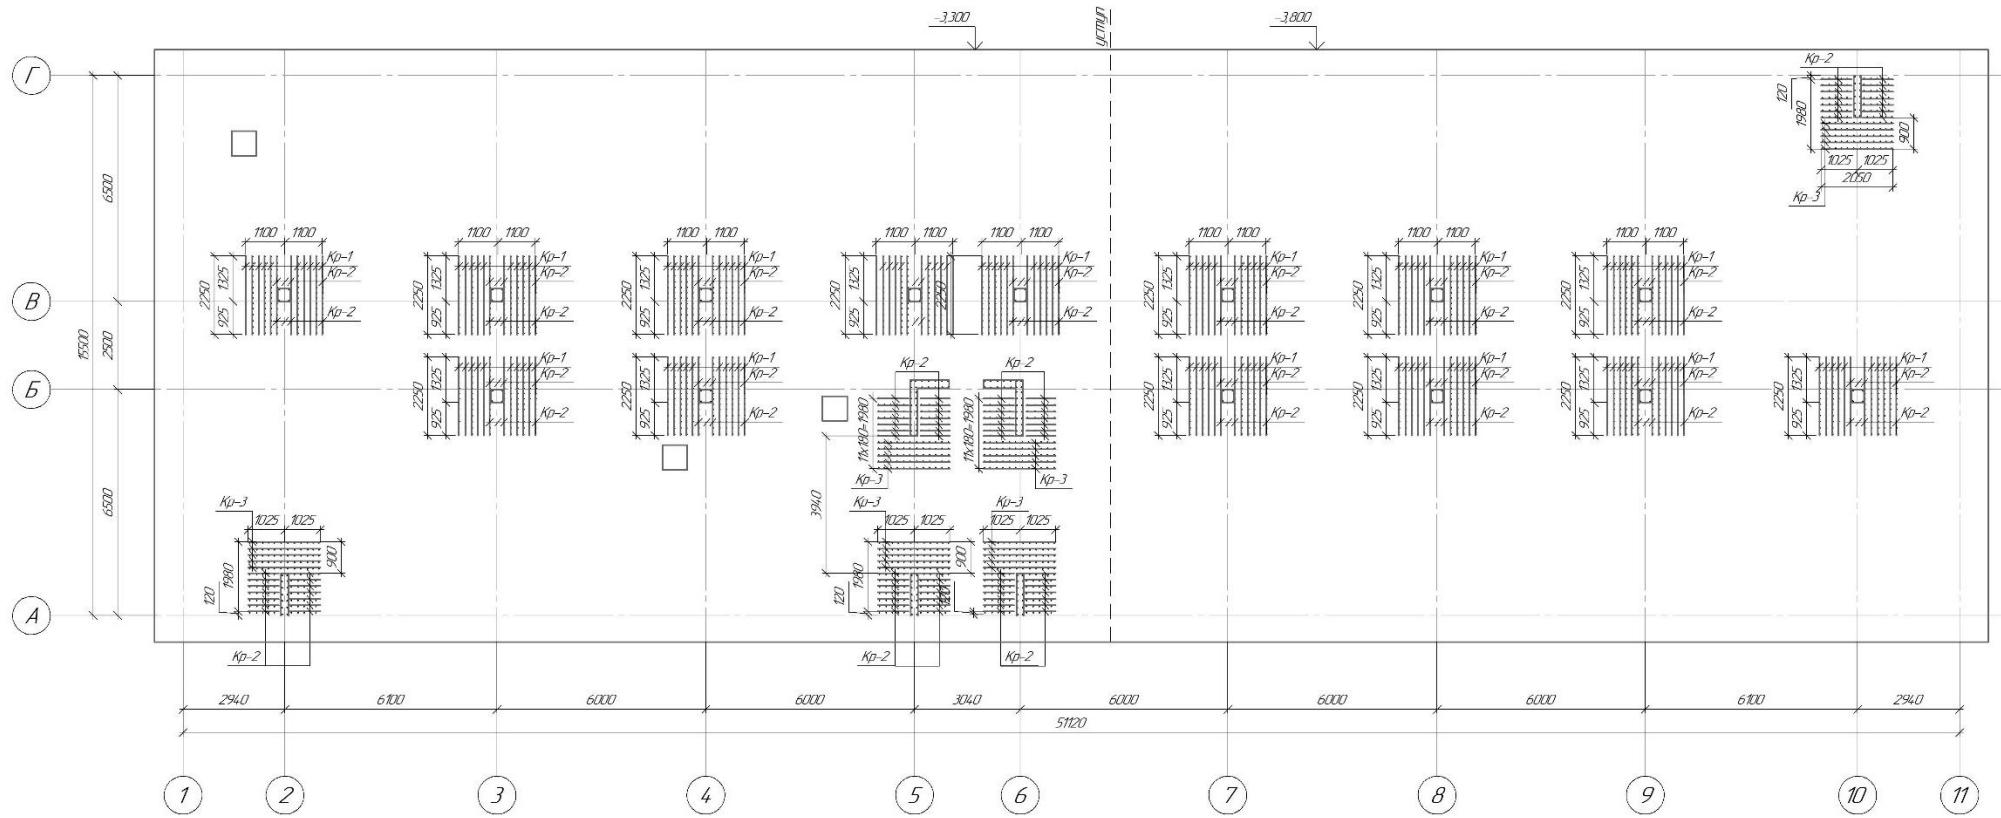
Схема расположения каркасов на продавливание в фундаментной плите
